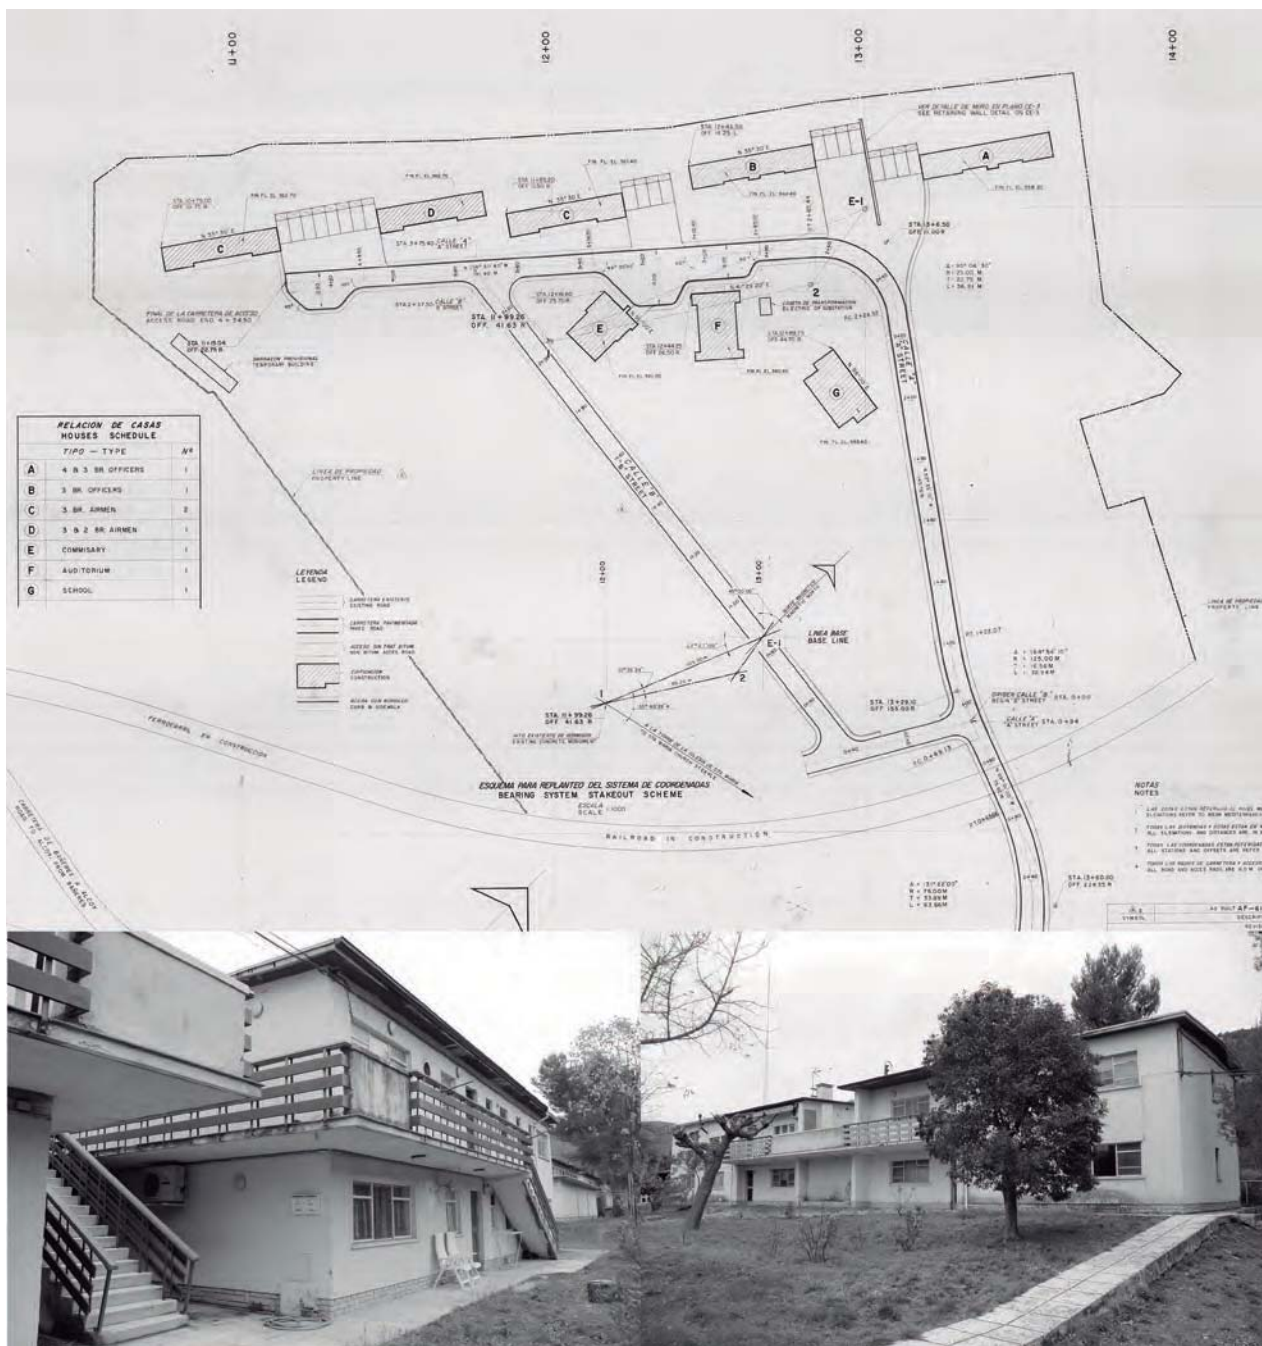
W-5 Alcoy. Planta general y fotografías de las fachadas. Fotografía: Ministerio de Defensa. Las fotografías pertenecen al autor.
